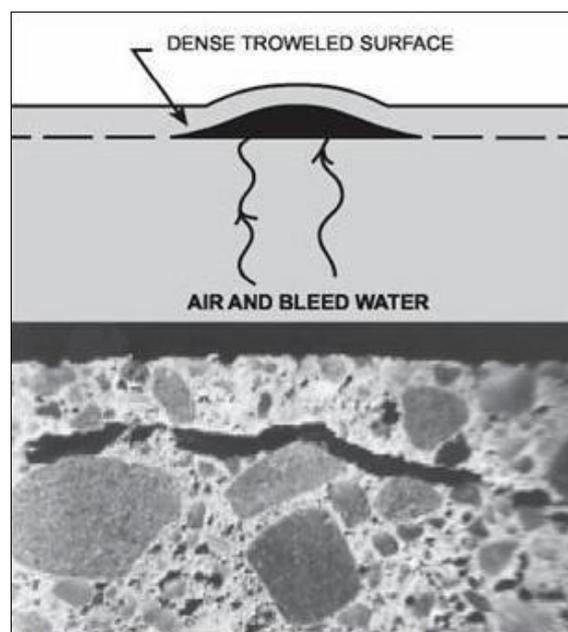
Esquema de formação de bolhas em pavimentos de betão [10]
